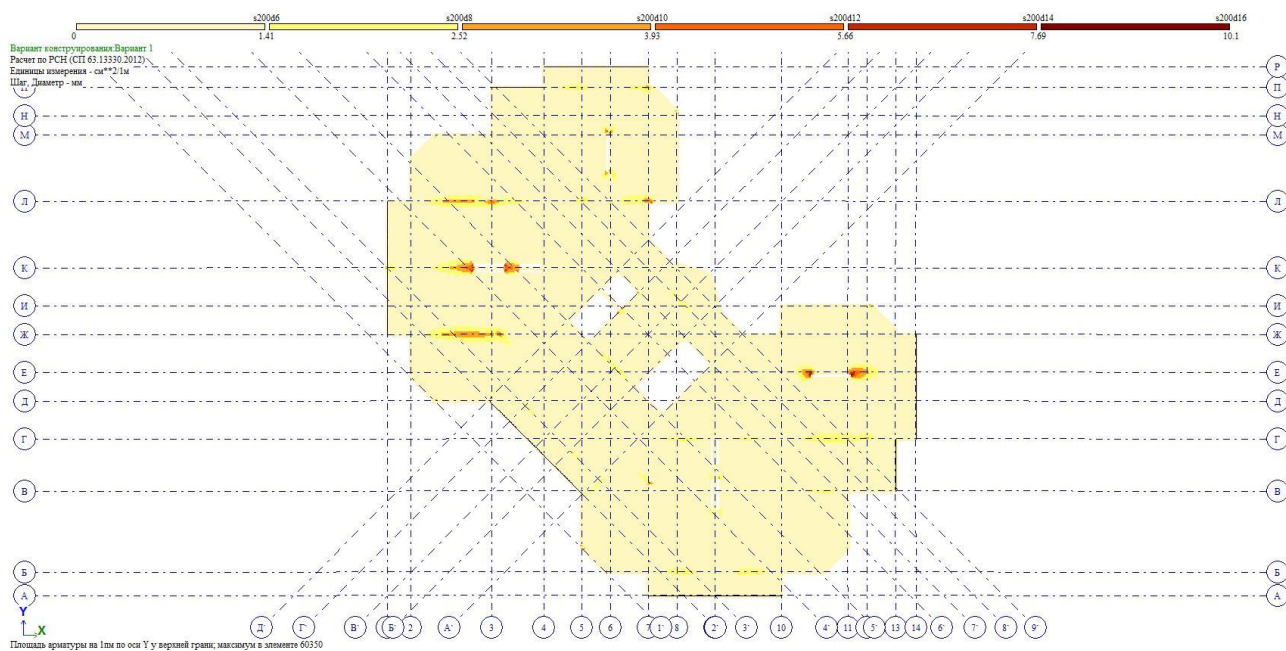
Армирование плиты монолитной верхней по оси Y
